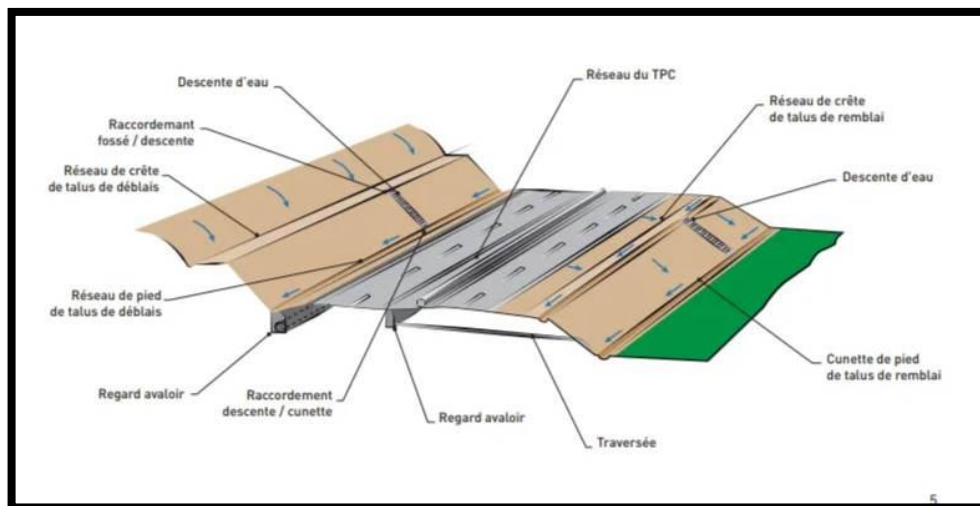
Situation des réseaux d'assainissement sur le profil en travers d'une route.
